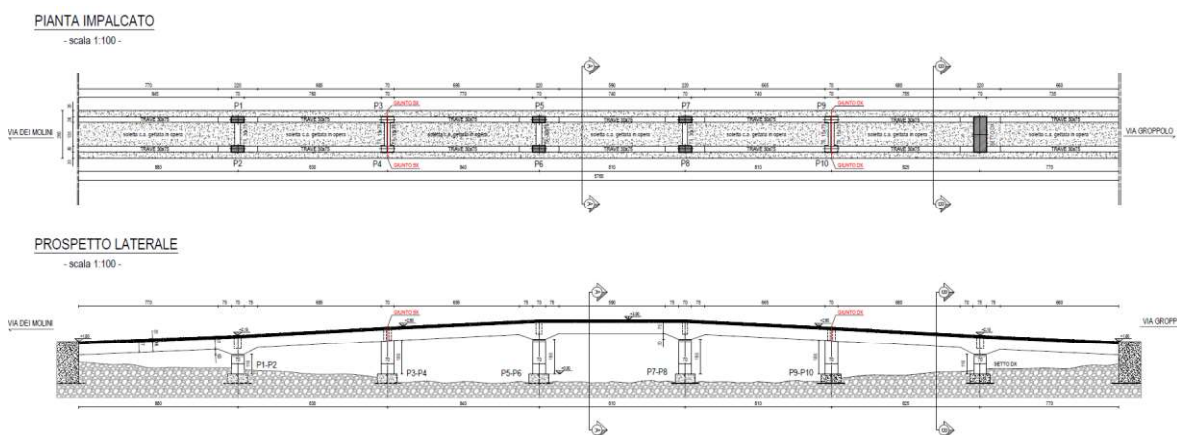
Planimetria e sezione longitudinale dell'attraversamento.
